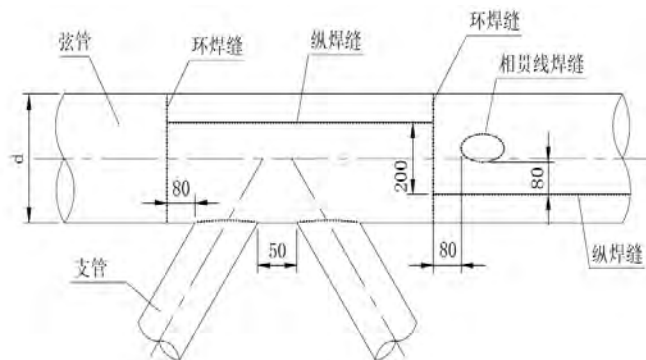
钢管拱弦管焊缝错开的最小距离（尺寸单位：mm）
